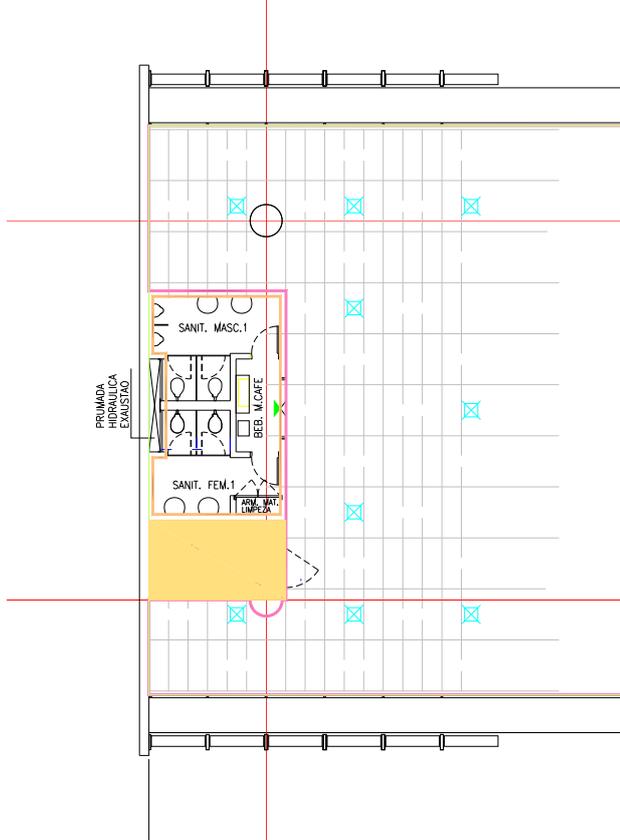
Pormenor da planta do pavimento, em 2005, observa-se apenas o acréscimo da área para equipamento de ar-condicionado conforme indicado em amarelo
